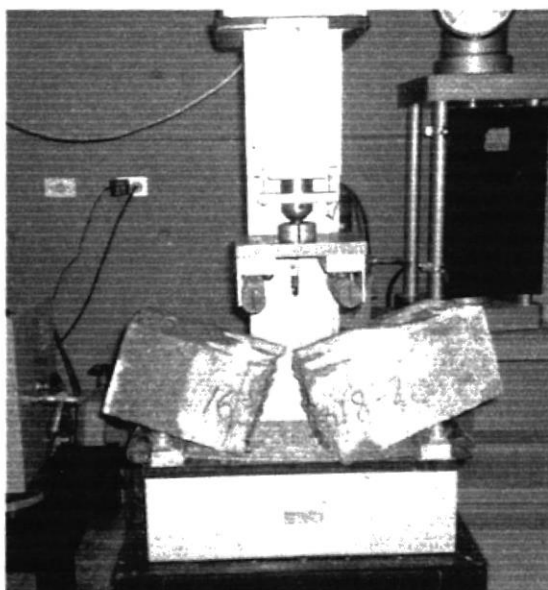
Procedimiento de colocado y centrado de la viga
